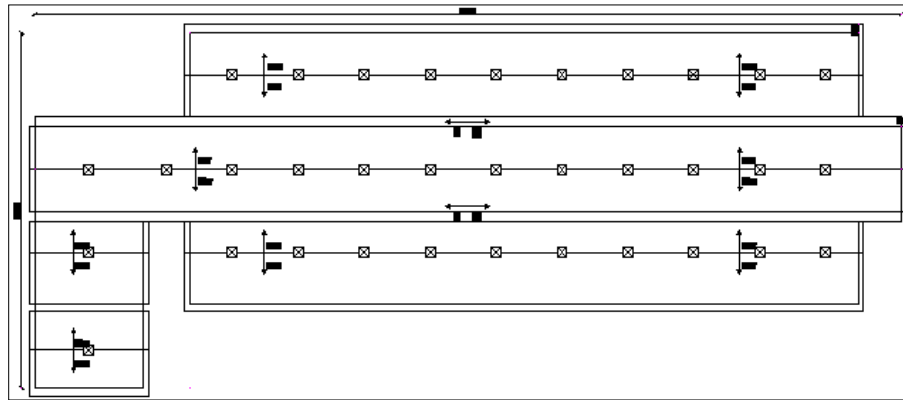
Plan de toiture (Elaborer par les auteurs)
